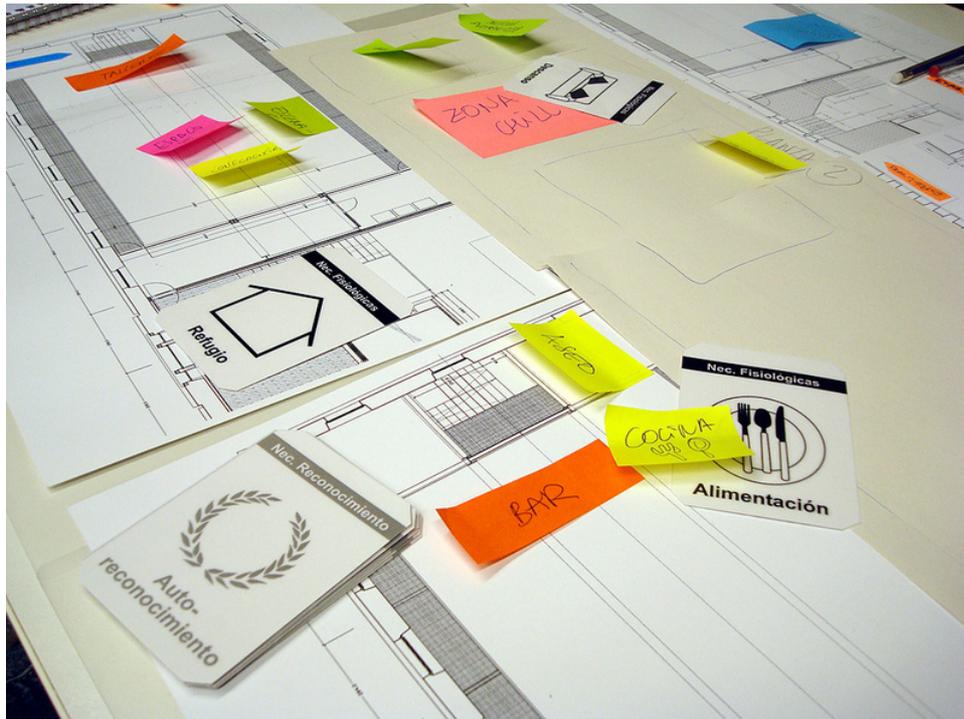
Construcción del Centro aplicado al plano de un inmueble vacío¹⁰⁰
